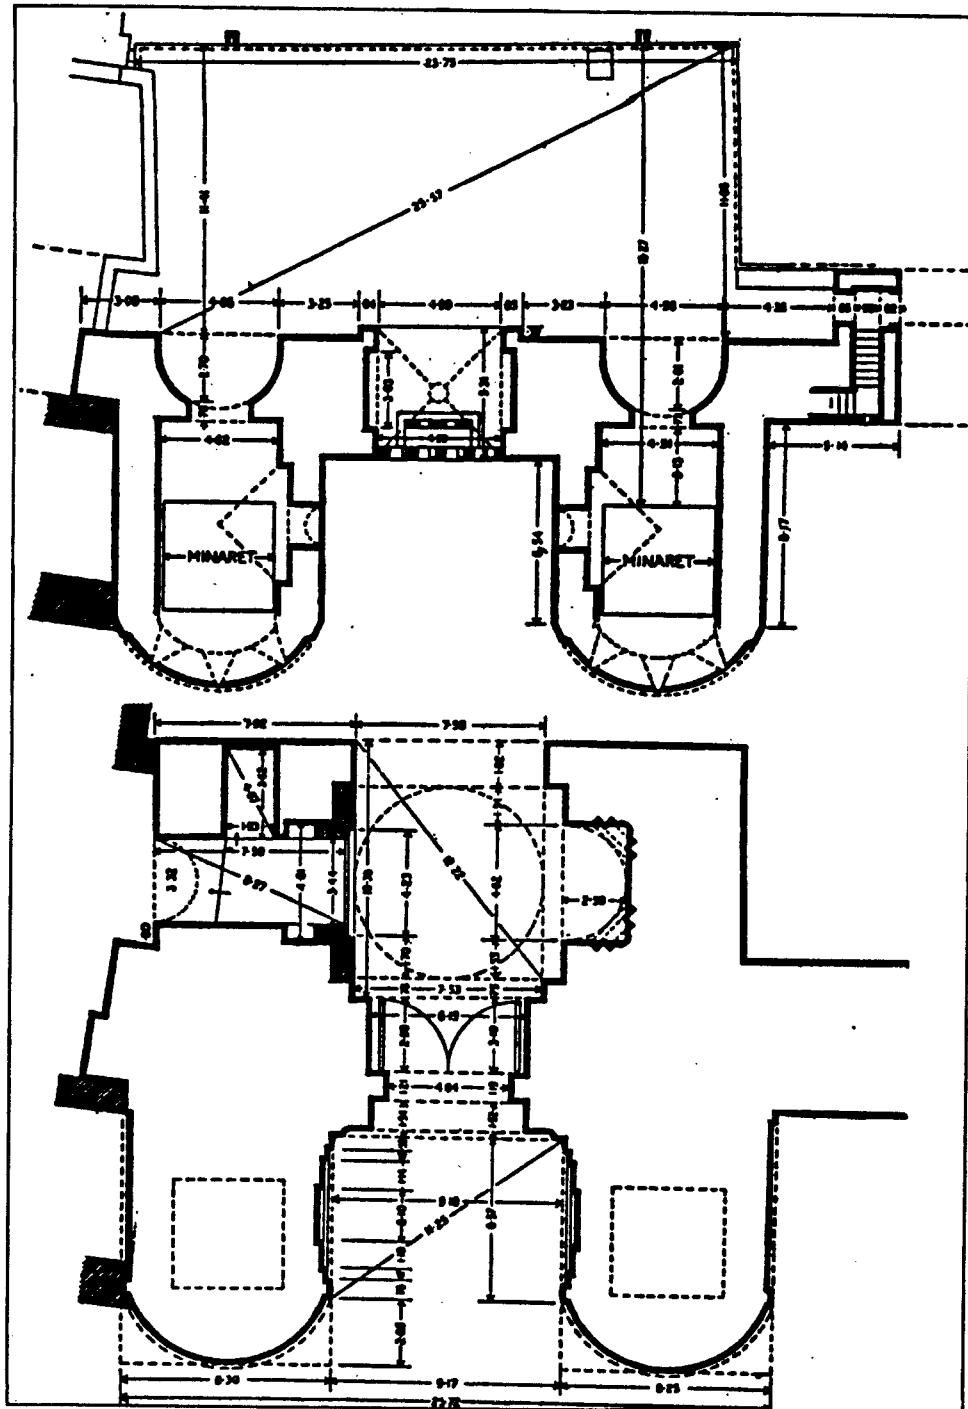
باب الفتوح، مسقط أفقى عن كريسوبل
